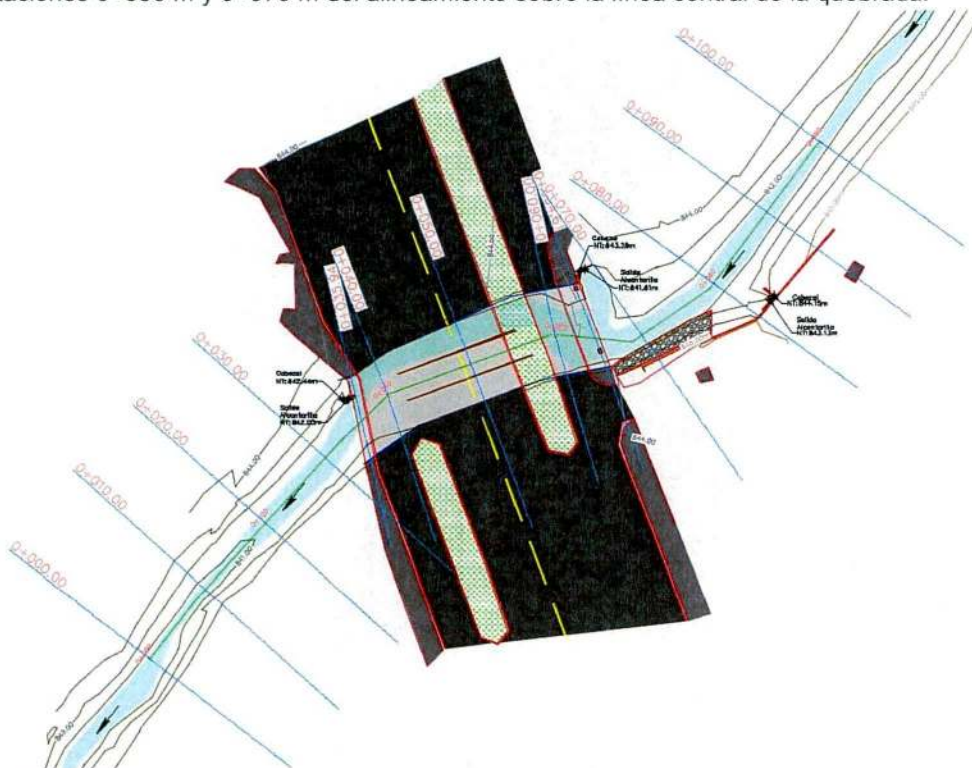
Levantamiento topográfico realizado en el sitio de la alcantarilla en la Quebrada Rodríguez
